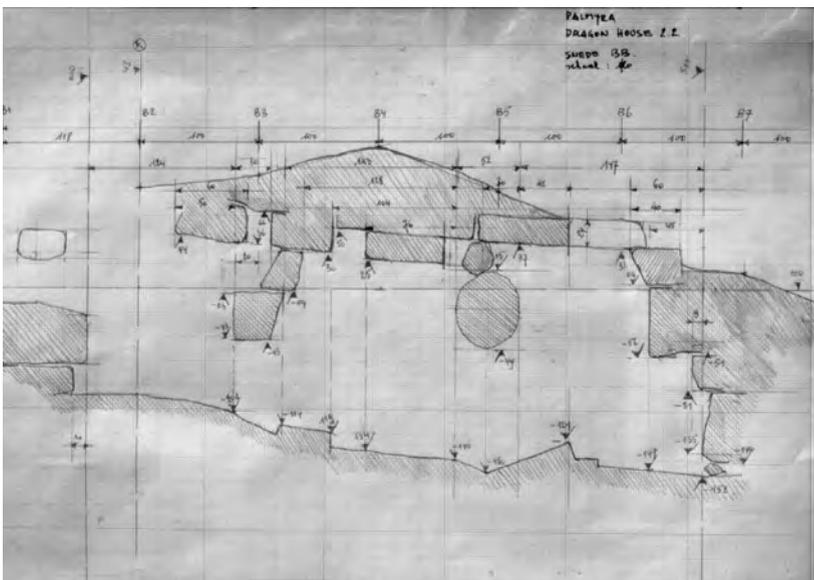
Palmyra, Steinbruch 2, Drachenhaus 2.2, Schnitt (P. Deneef)
